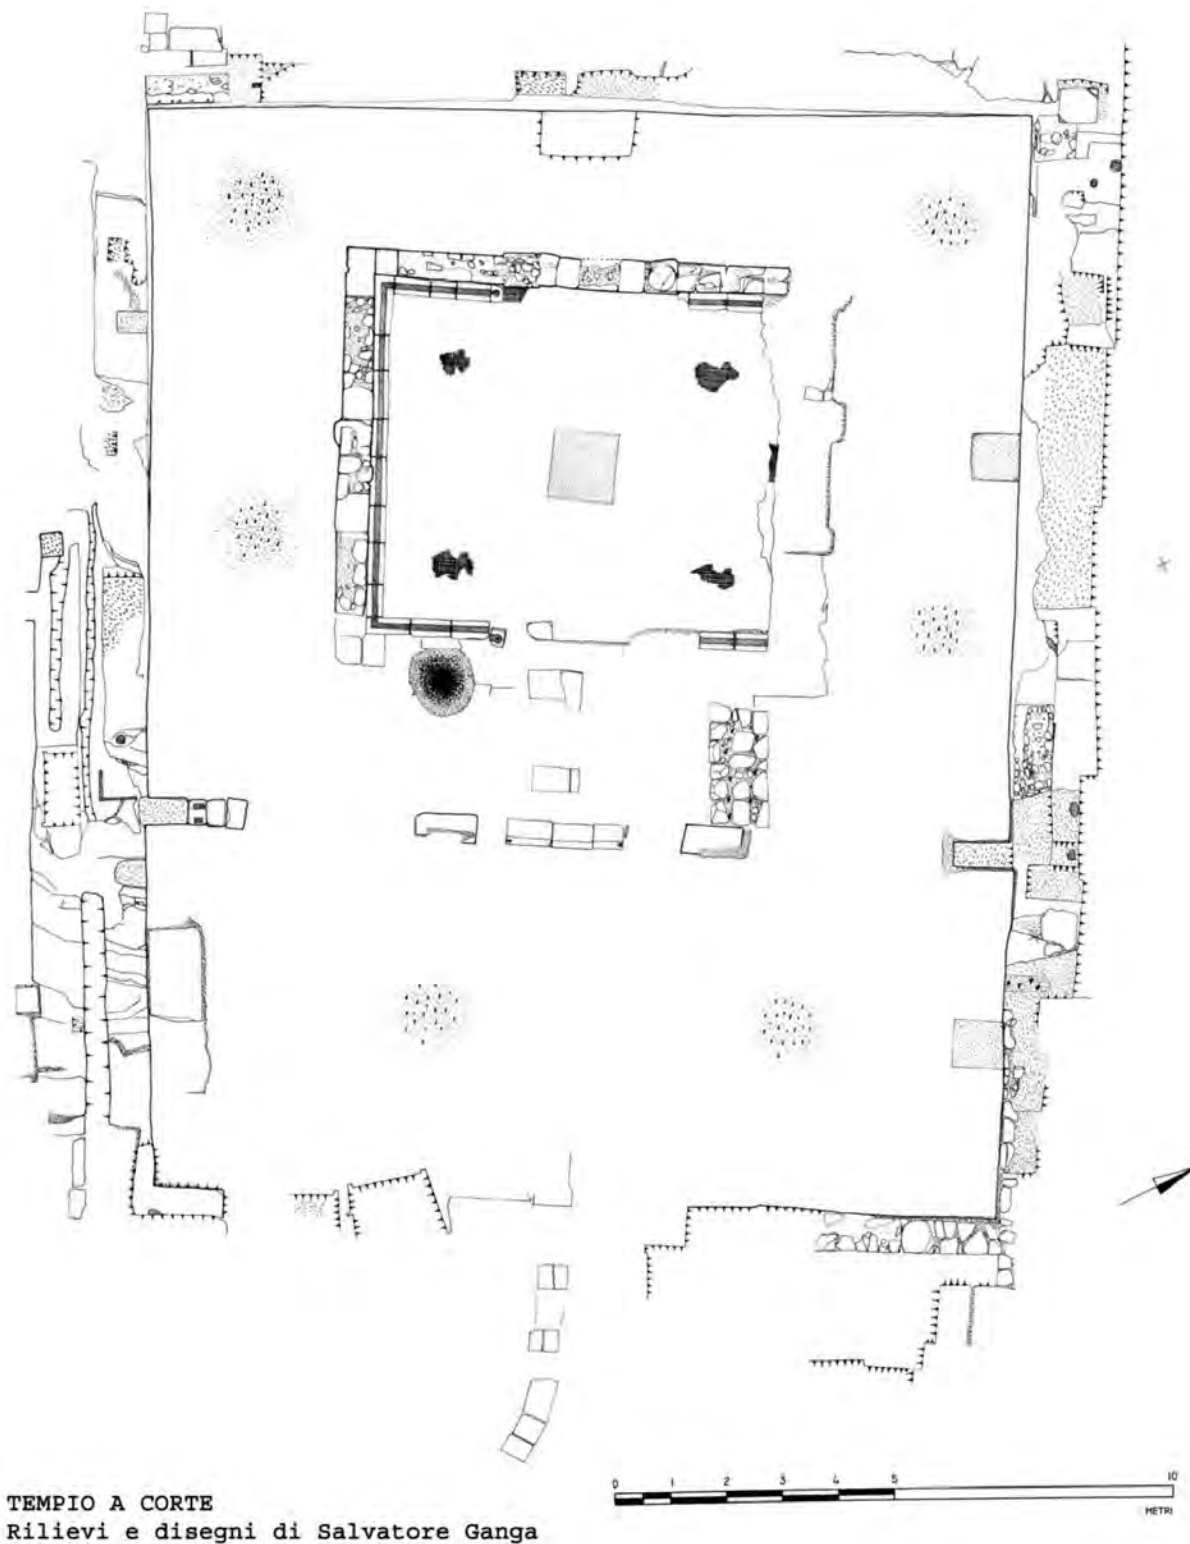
Planimetria del "Tempio a pianta di tipo semitico". Rilievi e disegni di Salvatore Ganga (da Floris, 2016).
